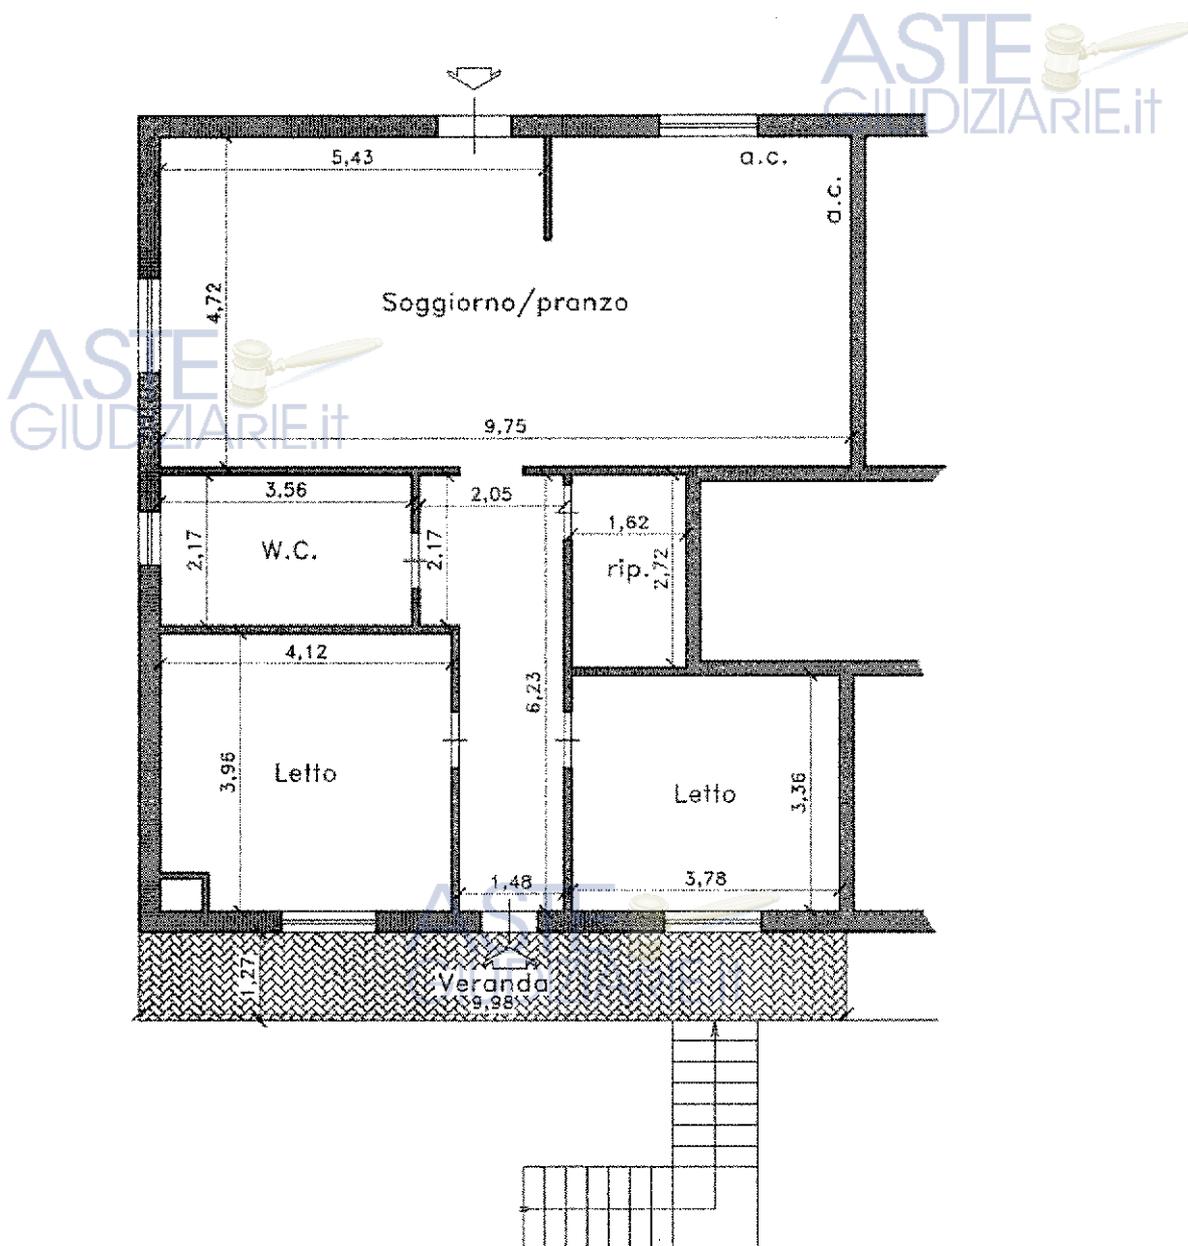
Planimetria quotata dell'appartamento al primo piano redatta dal CTU a seguito del rilievo effettuato
